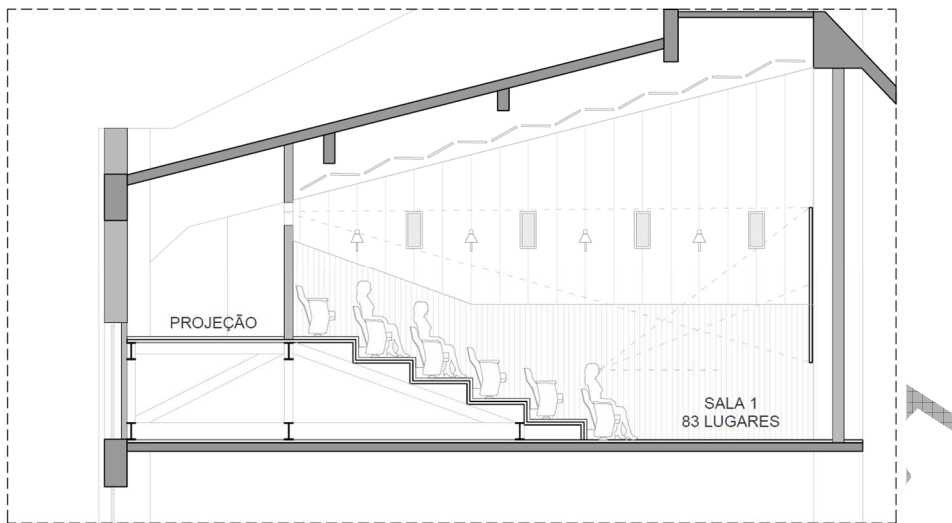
Planta da proposta de implantação de cinema no quarto pavimento do GASÔMETRO
